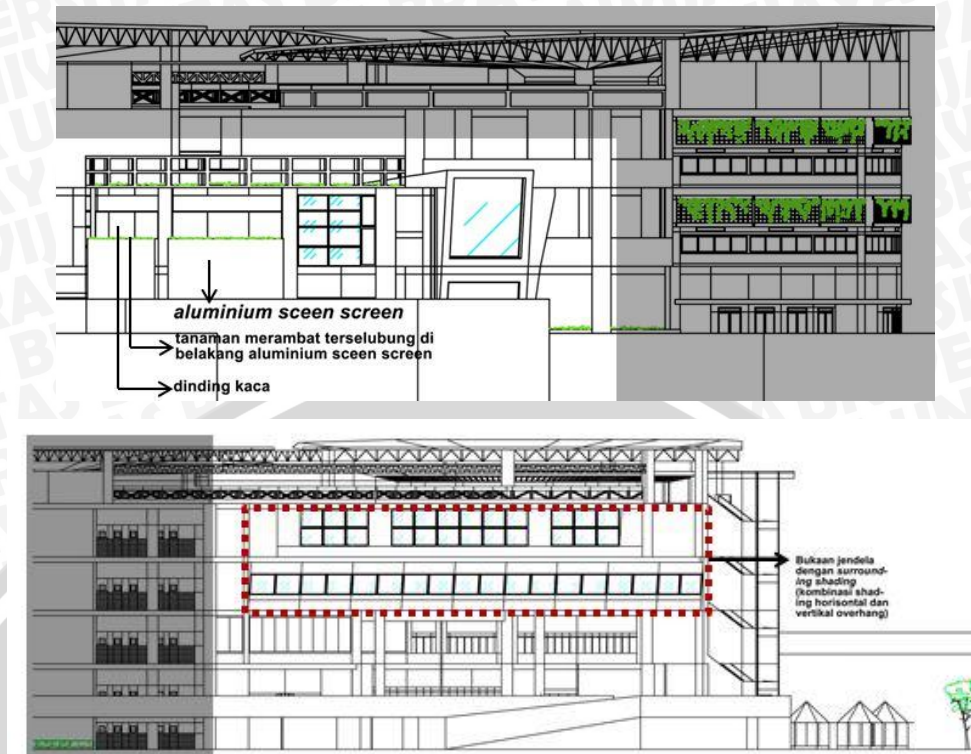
Bentuk fasad pada lantai 3 dan 4
